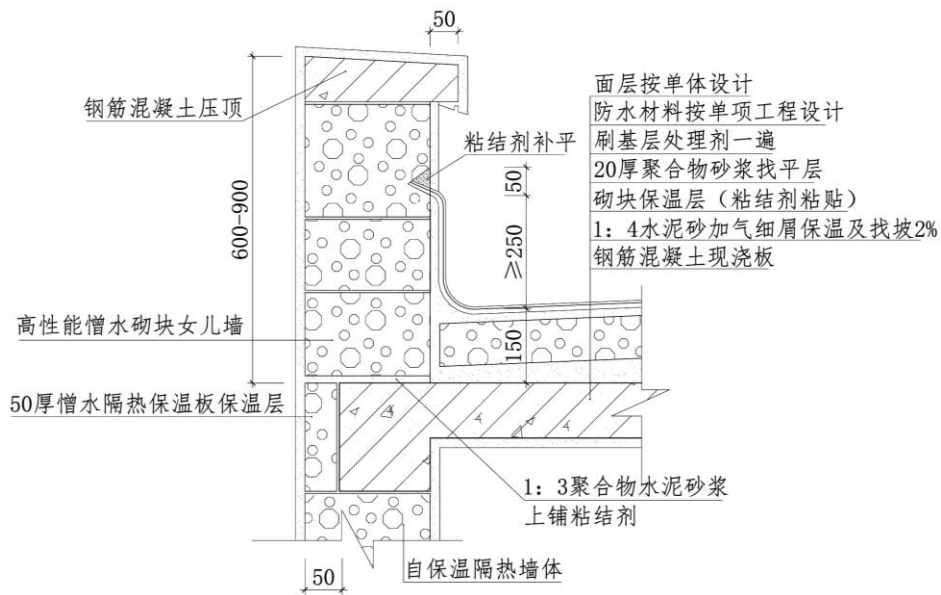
屋面保温防水构造（不上人屋面）
